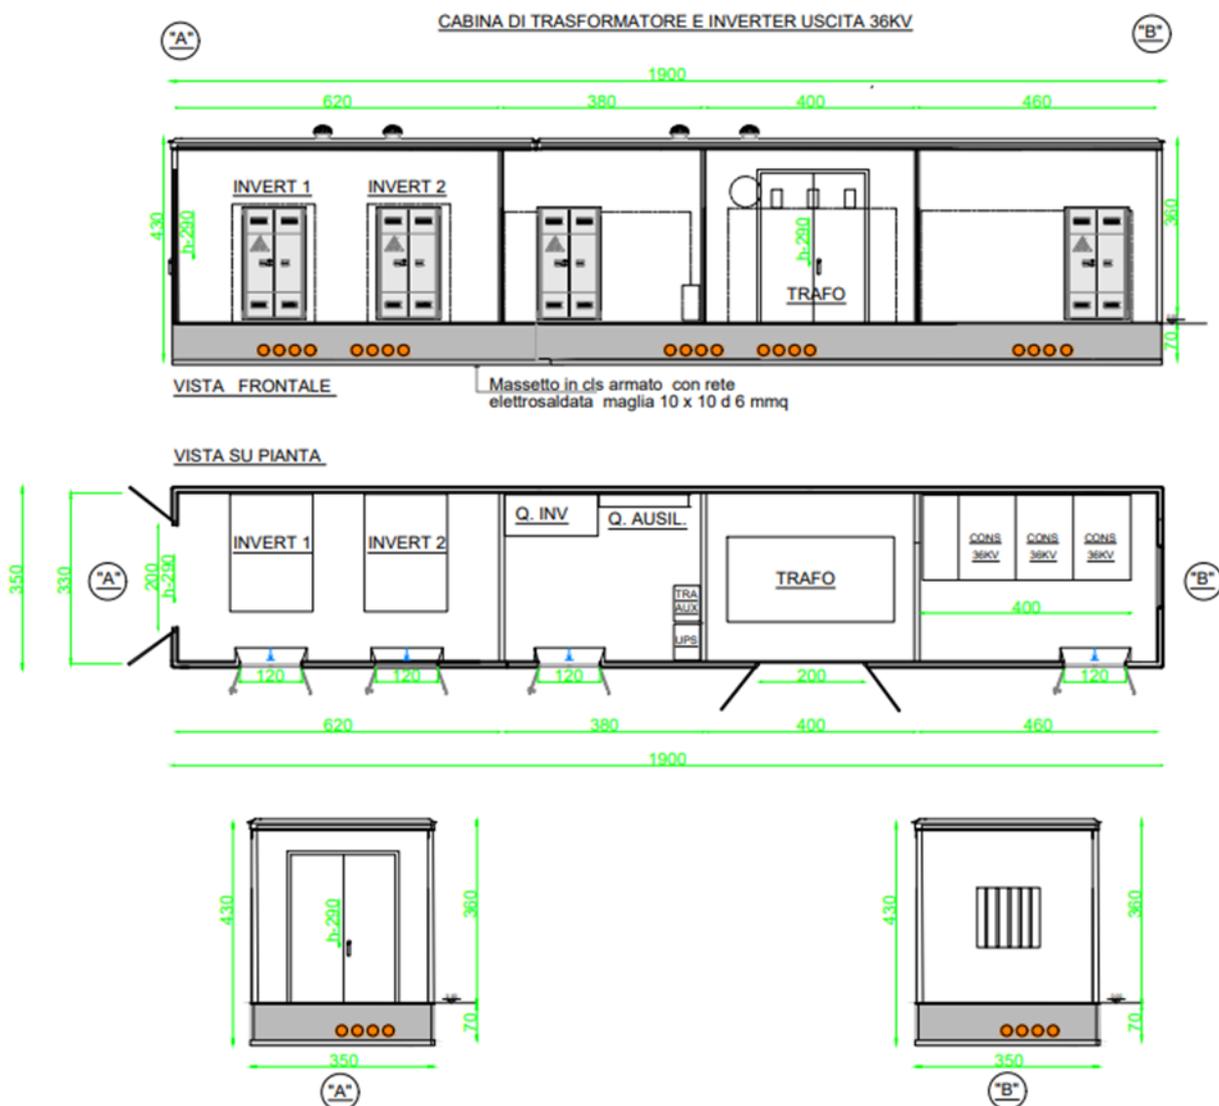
Planimetria e prospetti dell'unità di trasformazione.
